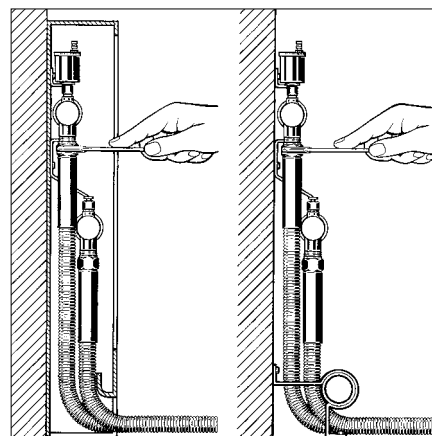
collegamento a regola d'arte del collettore nell'armadio a muro e sulla parete.
